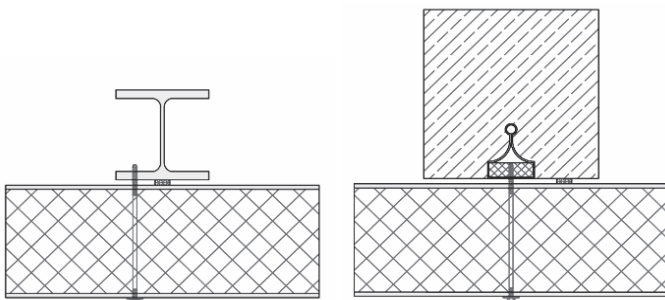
Befestigung von horizontal verlegten Wandsandwichelementen an Stahl- bzw. Stahlbetonstützen
